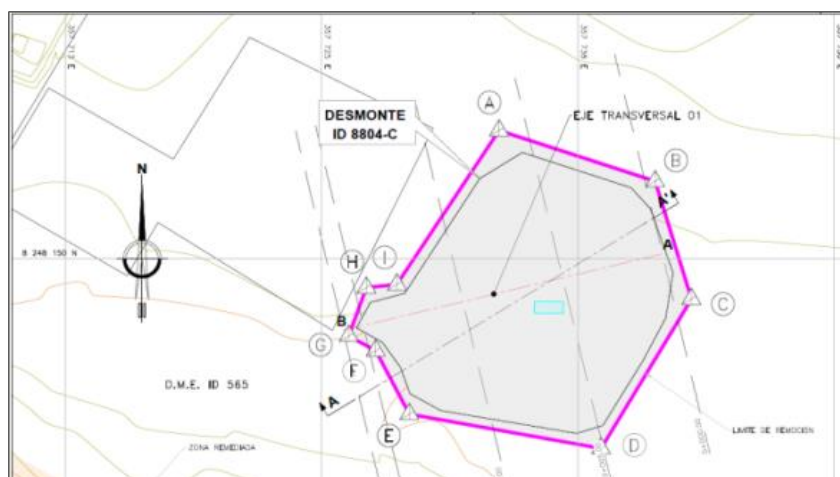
Vista en planta desmonte de mina ID 8804-C
